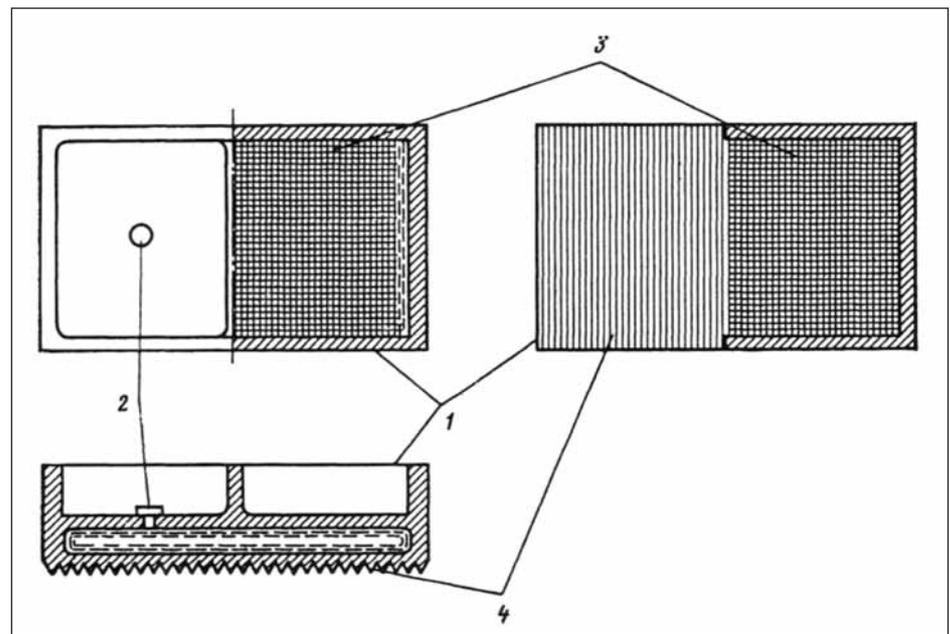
Тюбинговая термопередающая крепь: 1 – корпус тюбинга; 2 – герметизирующая кнопка; 3 – пористый (сетчатый) материал; 4 – резьба наружной стенки
